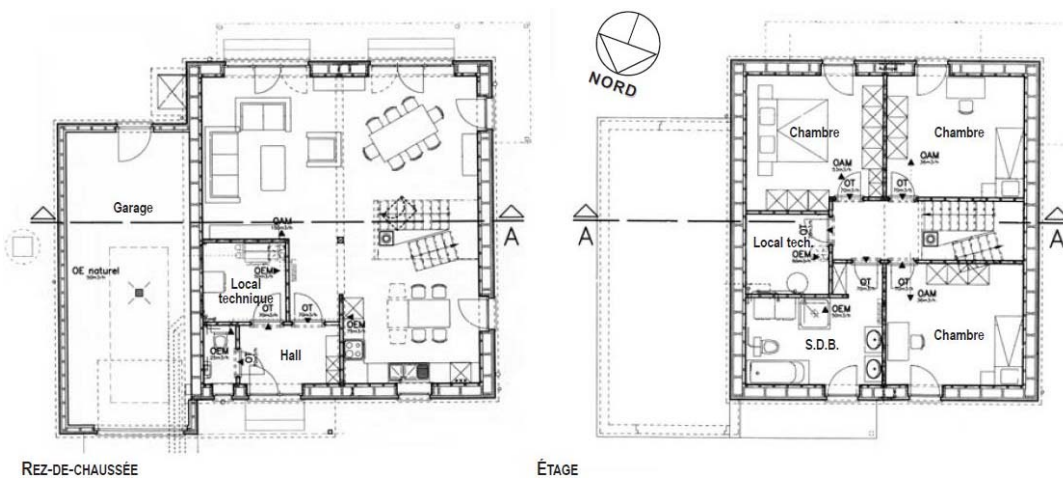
Plan du rez-de-chaussée et du premier étage de la maison Kettenis (Région Wallone, 2004)
